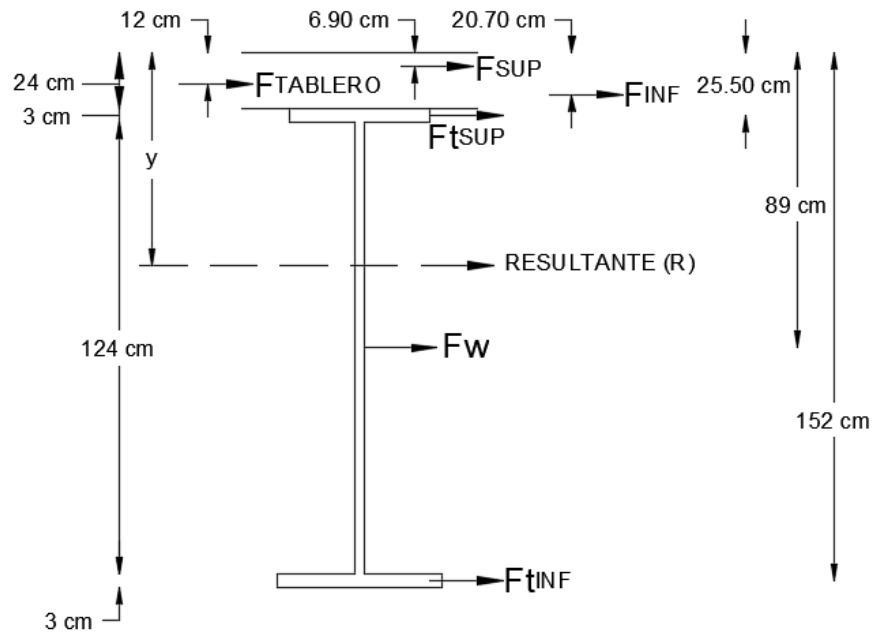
Localización del eje neutro plástico en el alma de la viga metálica. Realizado por: Autor
